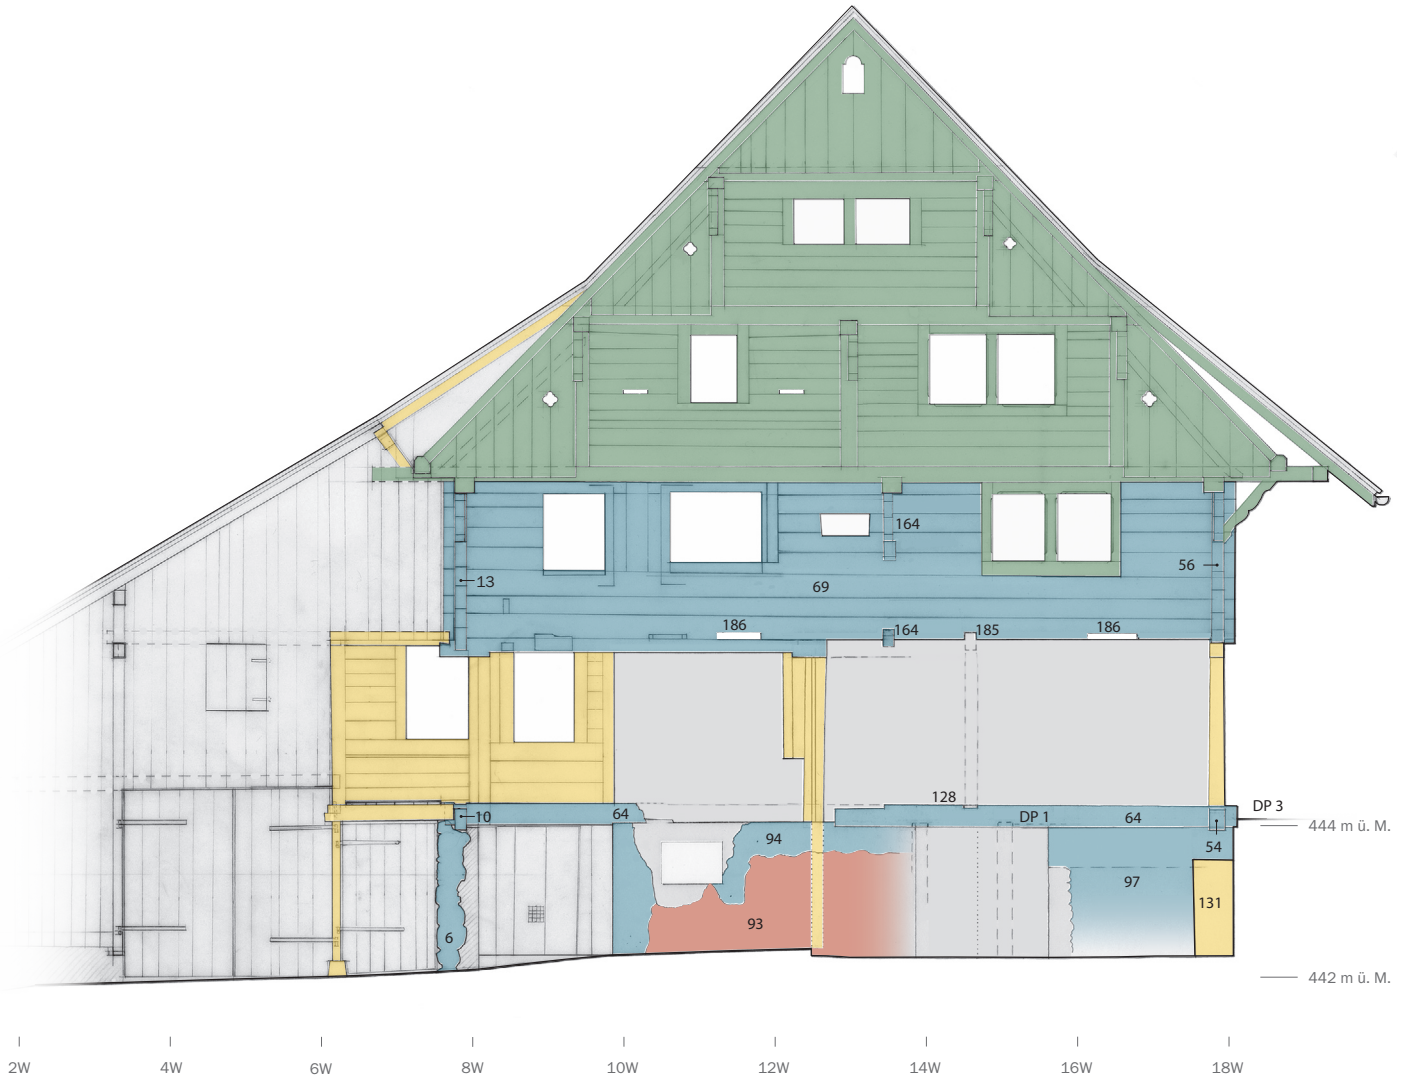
Burghaus Hüenberg, Nordfassade, Phasenplan.
